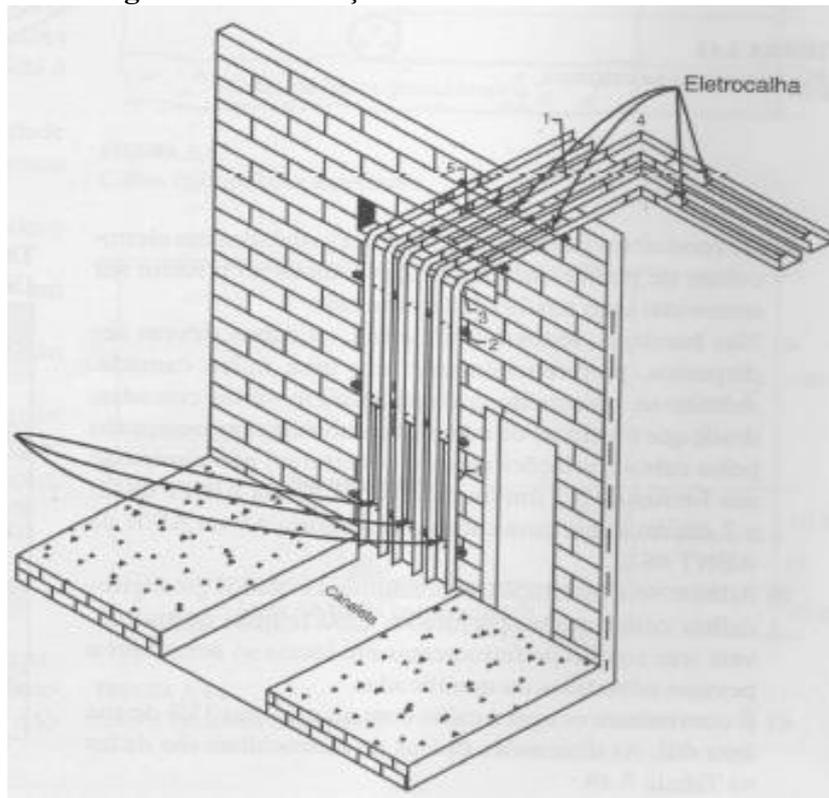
Fixação de eletrocalha tipo escada na estrutura.
